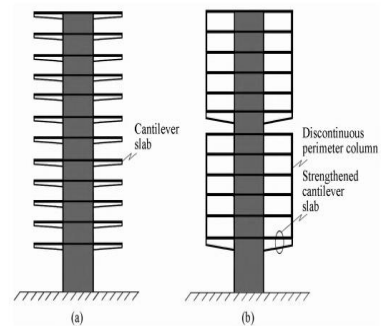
Figure 3.8 Dalles dans les systèmes à noyau : (a) dalles en porte-à-faux, (b) dalles cantilever renforcées
